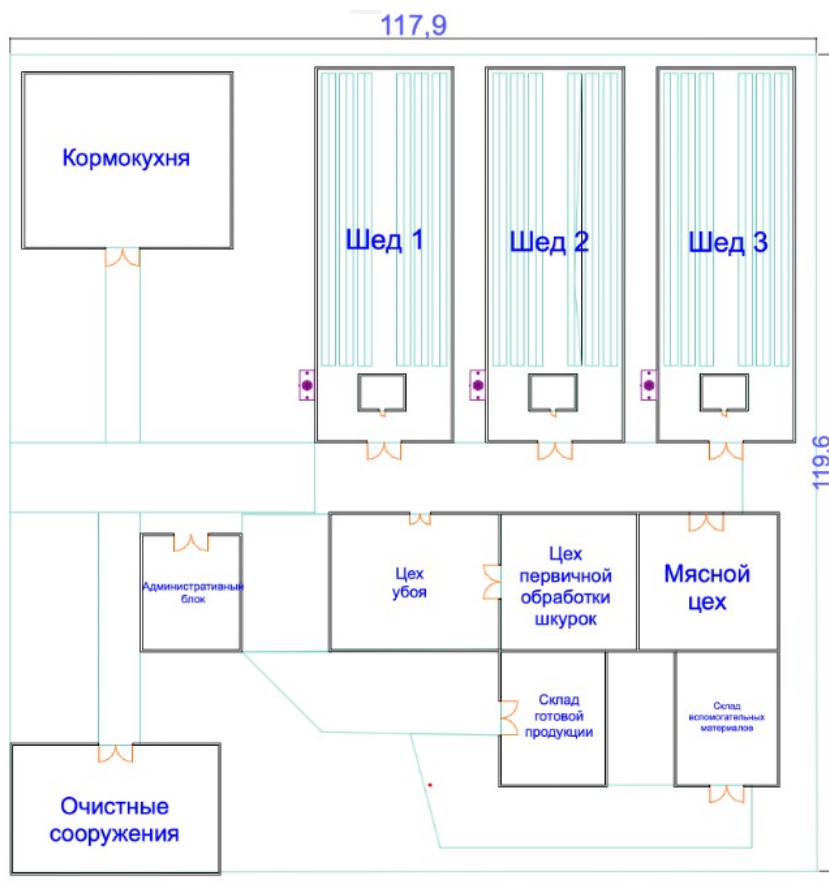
Проект генерального плана участка кролиководческой фермы
